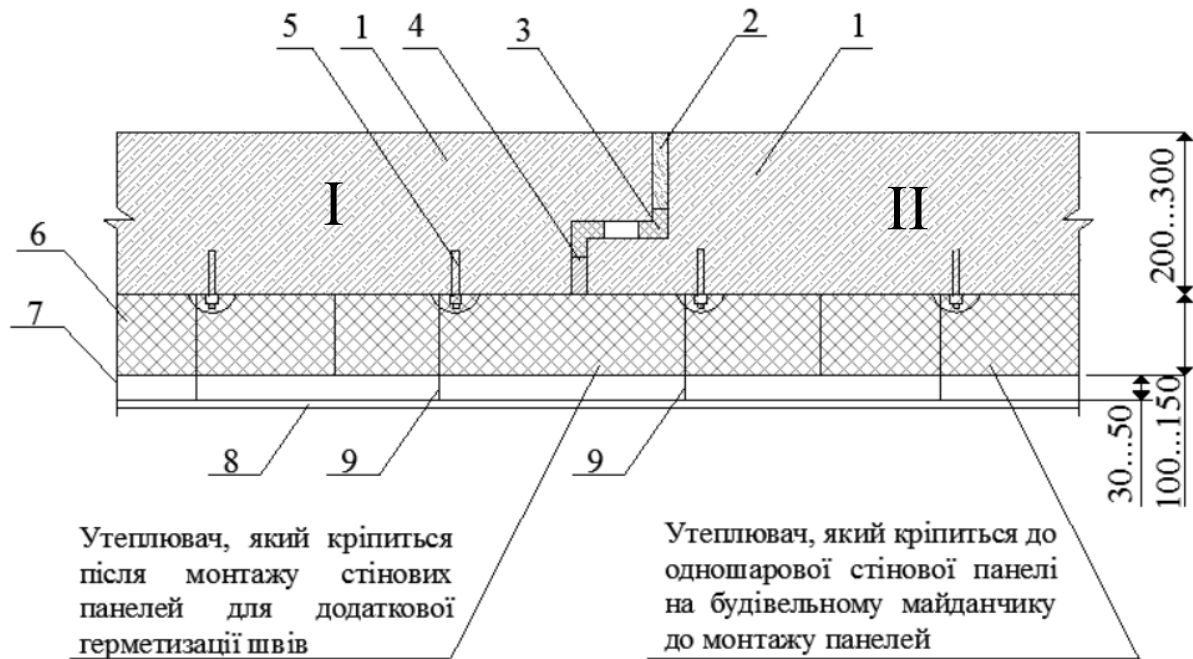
Схема зовнішнього утеплення одношарових стінових панелей системою вентилязованого фасаду: 1 – одношарова або двошарова стінова панель; 2 – цементно-піщаний розчин; 3 – пружна прокладка; 4 – герметизаційна мастика; 5 – анкерний дюбель; 6 – теплоізоляційний матеріал; 7 – вентиляований повітряний прошарок; 8 – плита керамогранітна; 9 – рядовий кронштейн
